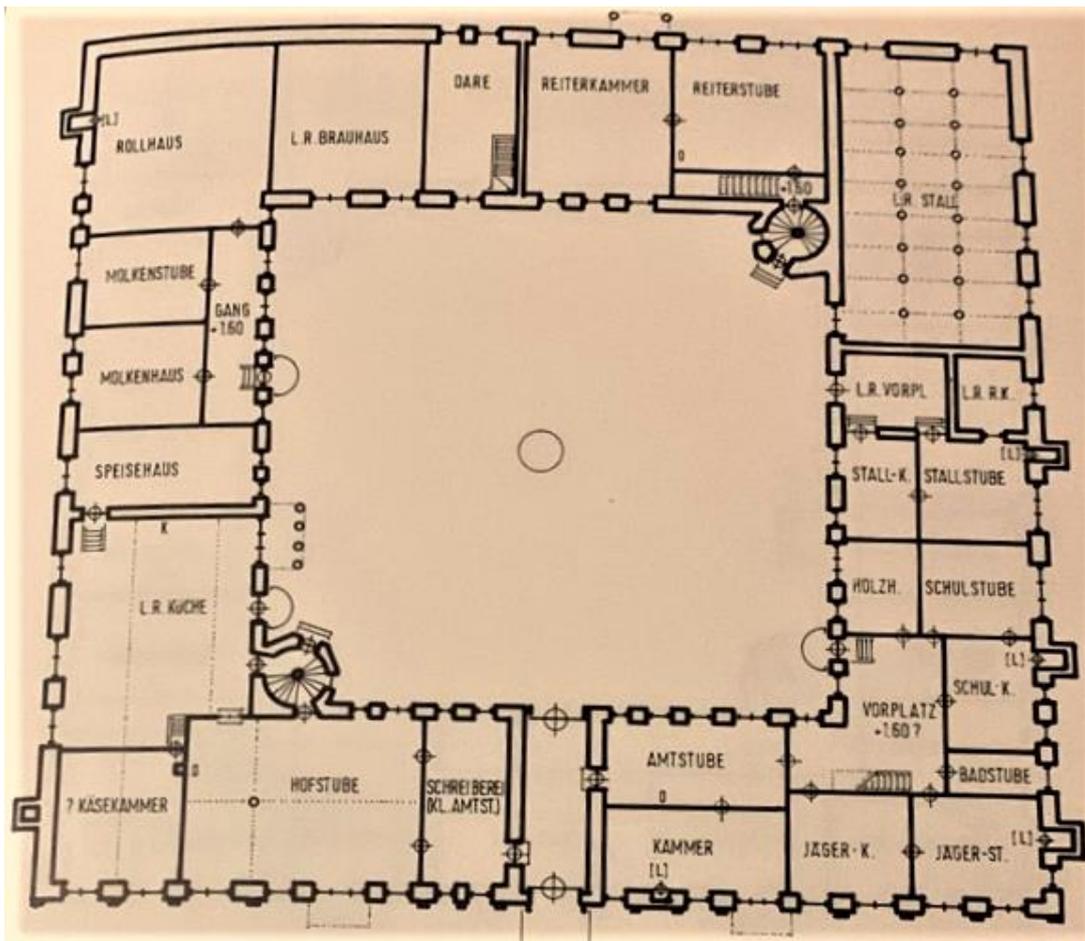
Grundriss Sockelgeschoss 1620/1652, aus: Krämer /Zadach-Buchmeier, 1992
